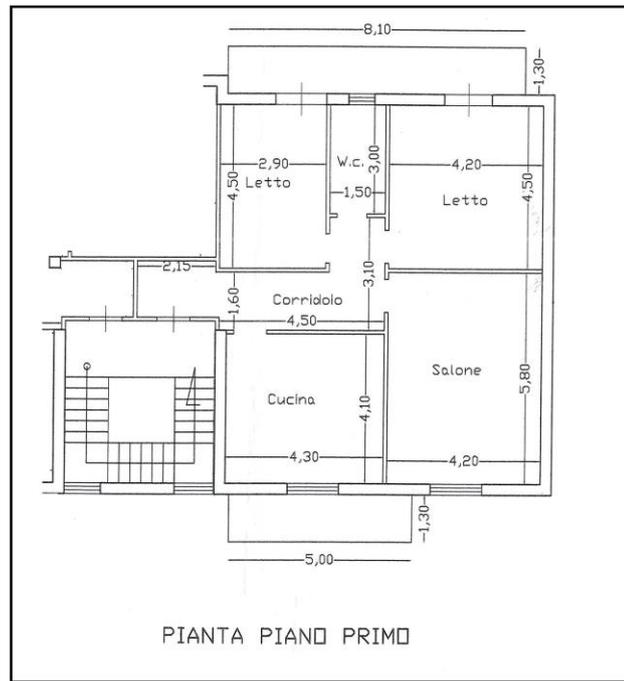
Planimetria allegata Concessione edilizia n. 507/2010 –
